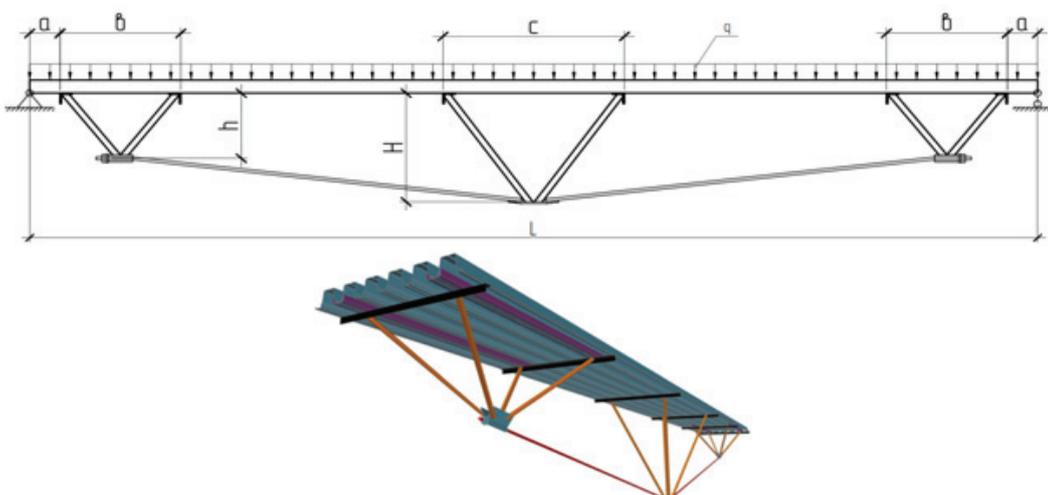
Схема конструктивного решения шпренгельных плит пролетом 12 м
